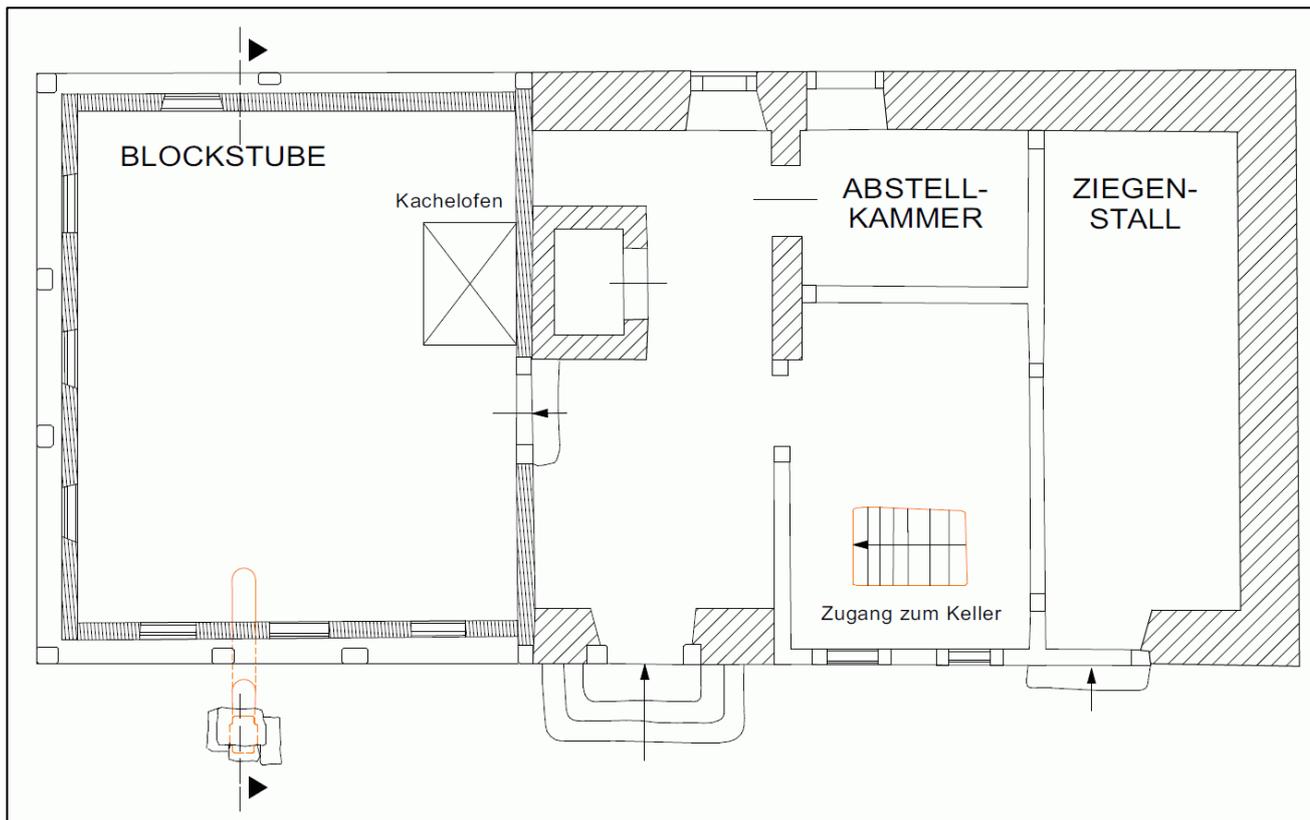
Anordnung Abluftanlage durch Außenwand, Grundriss
